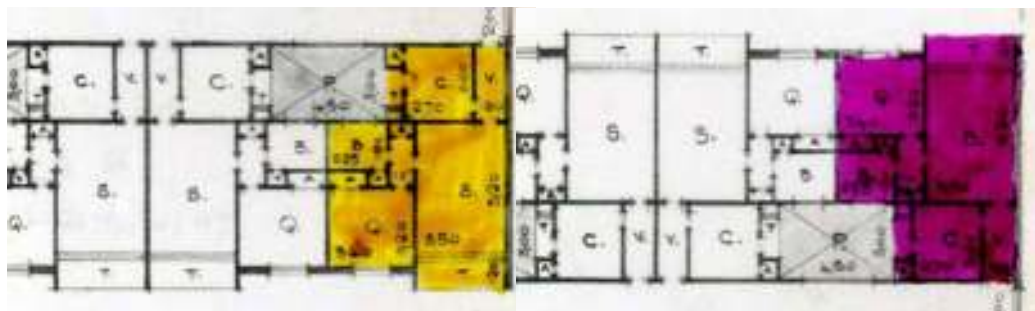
Detalhe das plantas dos apartamentos do edifício tipo D1.
